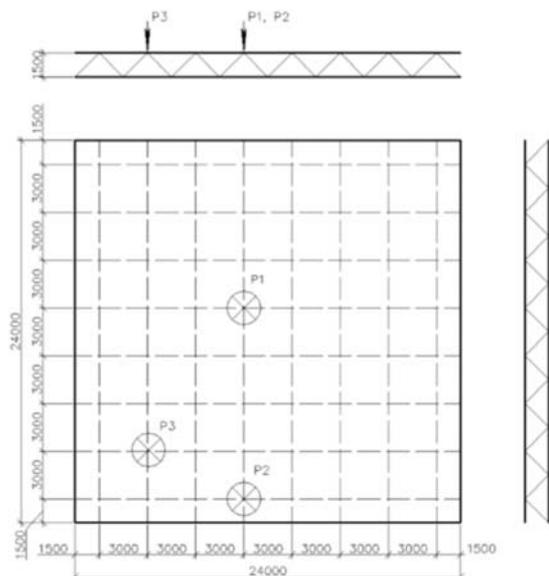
Расчетная схема пространственной фундаментной платформы
